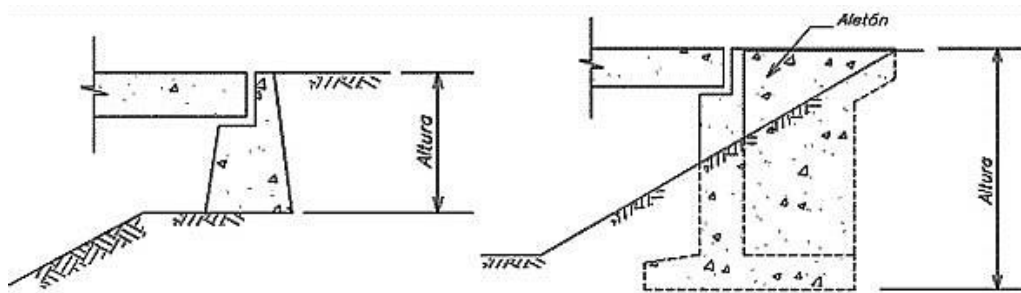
Muro de gravedad (izquierda) y muro en voladizo (derecha).
